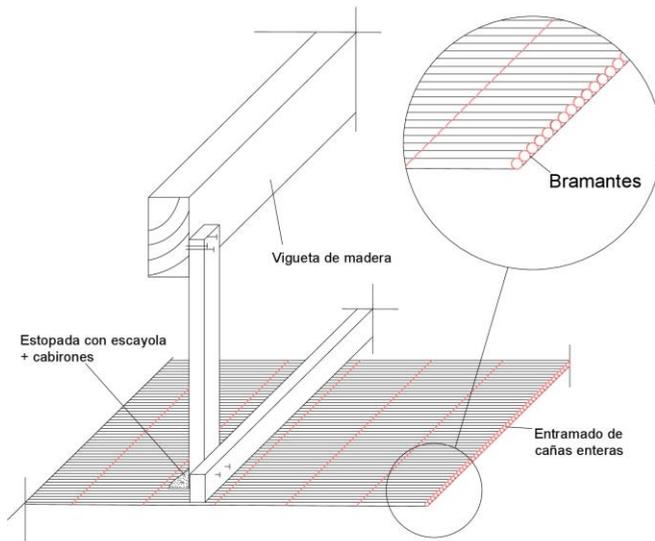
Detalle de cubierta de la vivienda cañizo. 2018. Fuente: Propia
